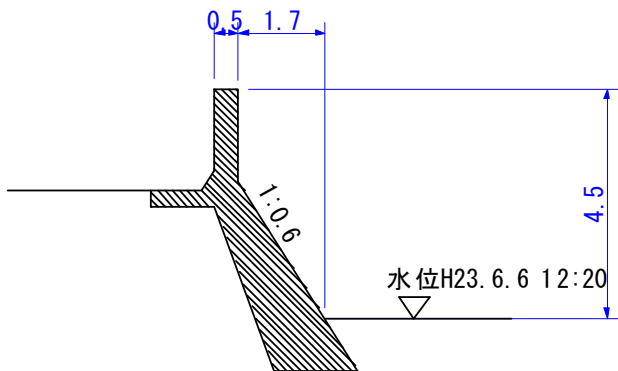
堤体断面図(No.11, 甲子川右岸, 鉄道橋付近, 図-16中の221, 単位 m)
